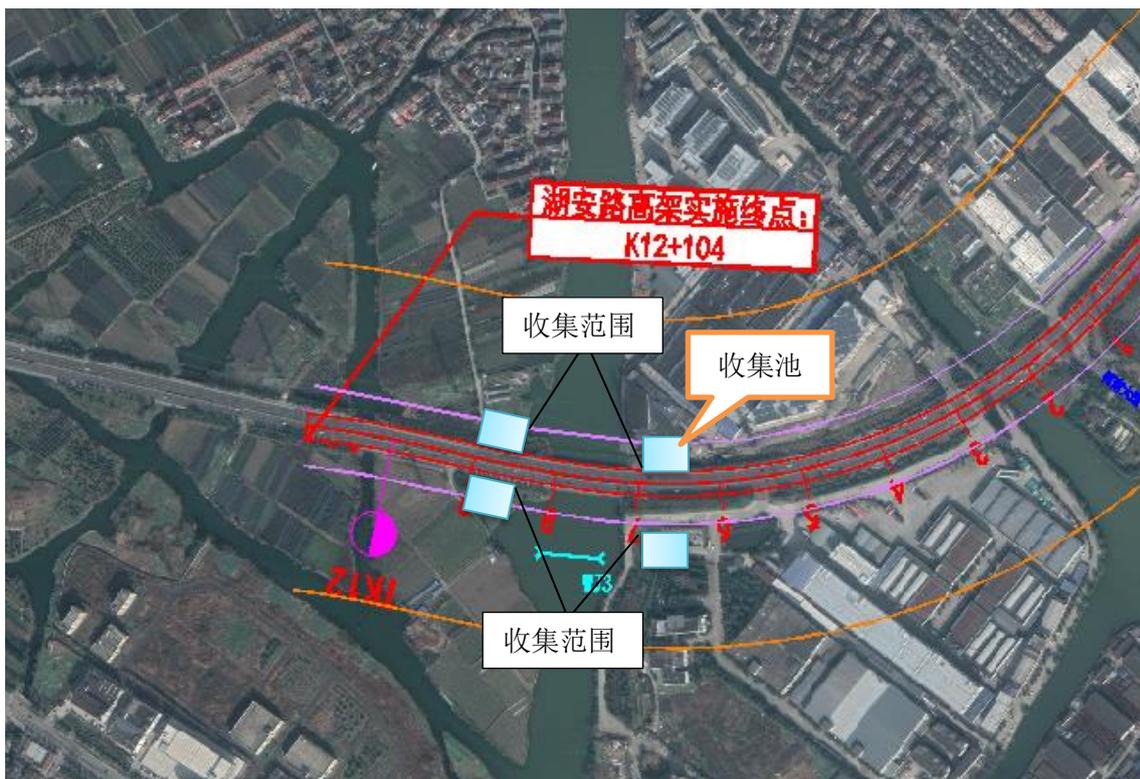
项目跨越柯夏线收集系统平面布置图
